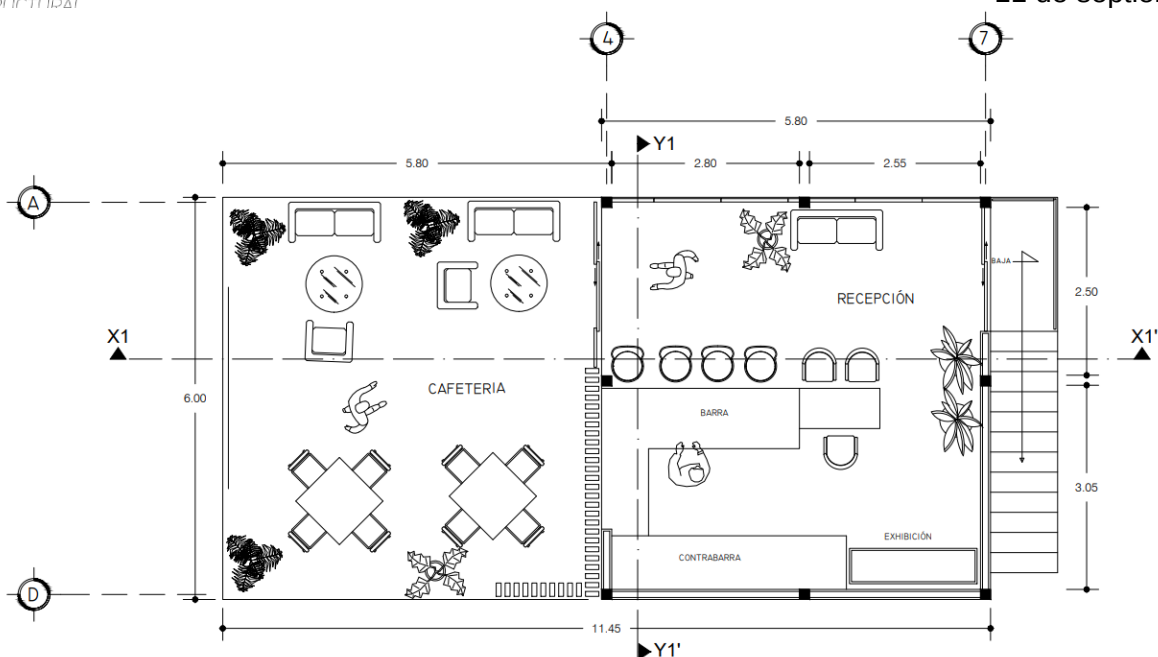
Arreglo general de cafetería y vestidores planta cafetería
